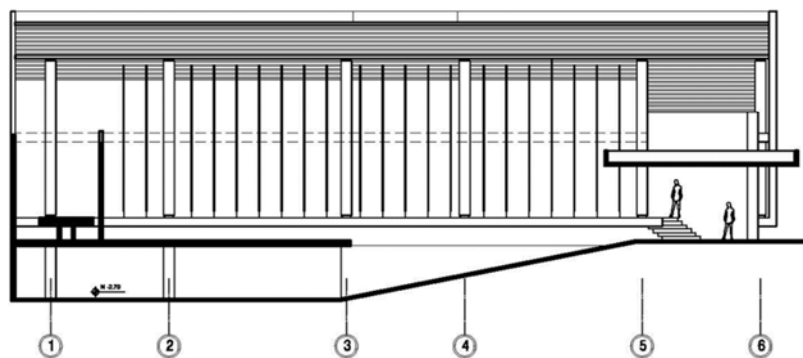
Plano arquitectónico. Fuente: Elaboración Propia
